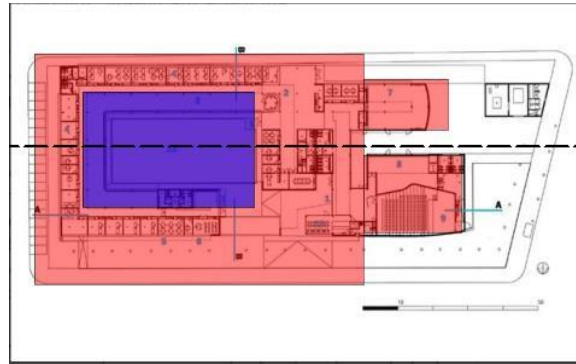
Estructuración del Conjunto, Centro Rosa Ziperovich
